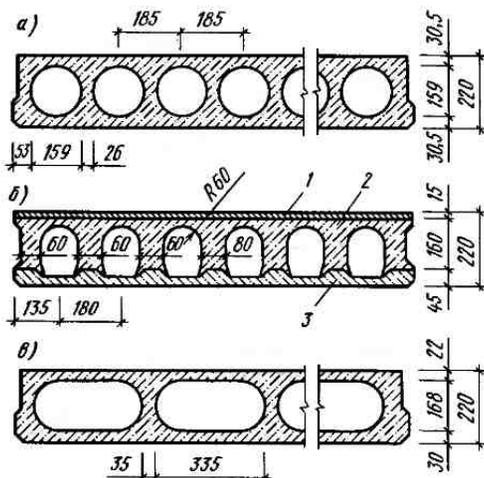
Многopустотные панели перекрытий: а — с круглыми пустотами, б — панели, изготавливаемые на установках с бетонящими комбайнами, в — панели с овальными пустотами, 1 — верхний слой, 2 — средний слой, 3 — нижний слой
